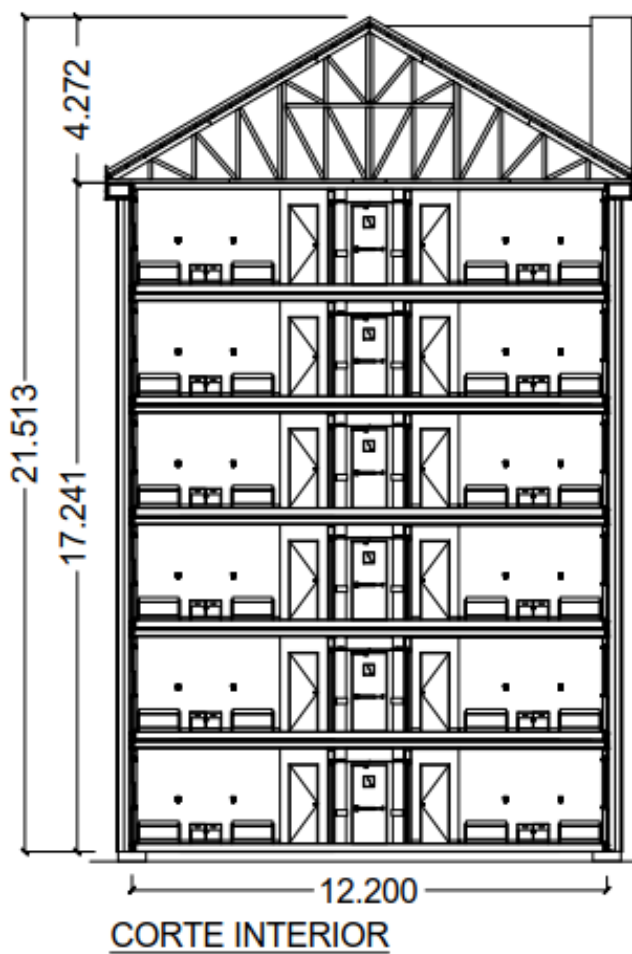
Corte en Elevación del Edificio Modular Prefabricado Proyectado
